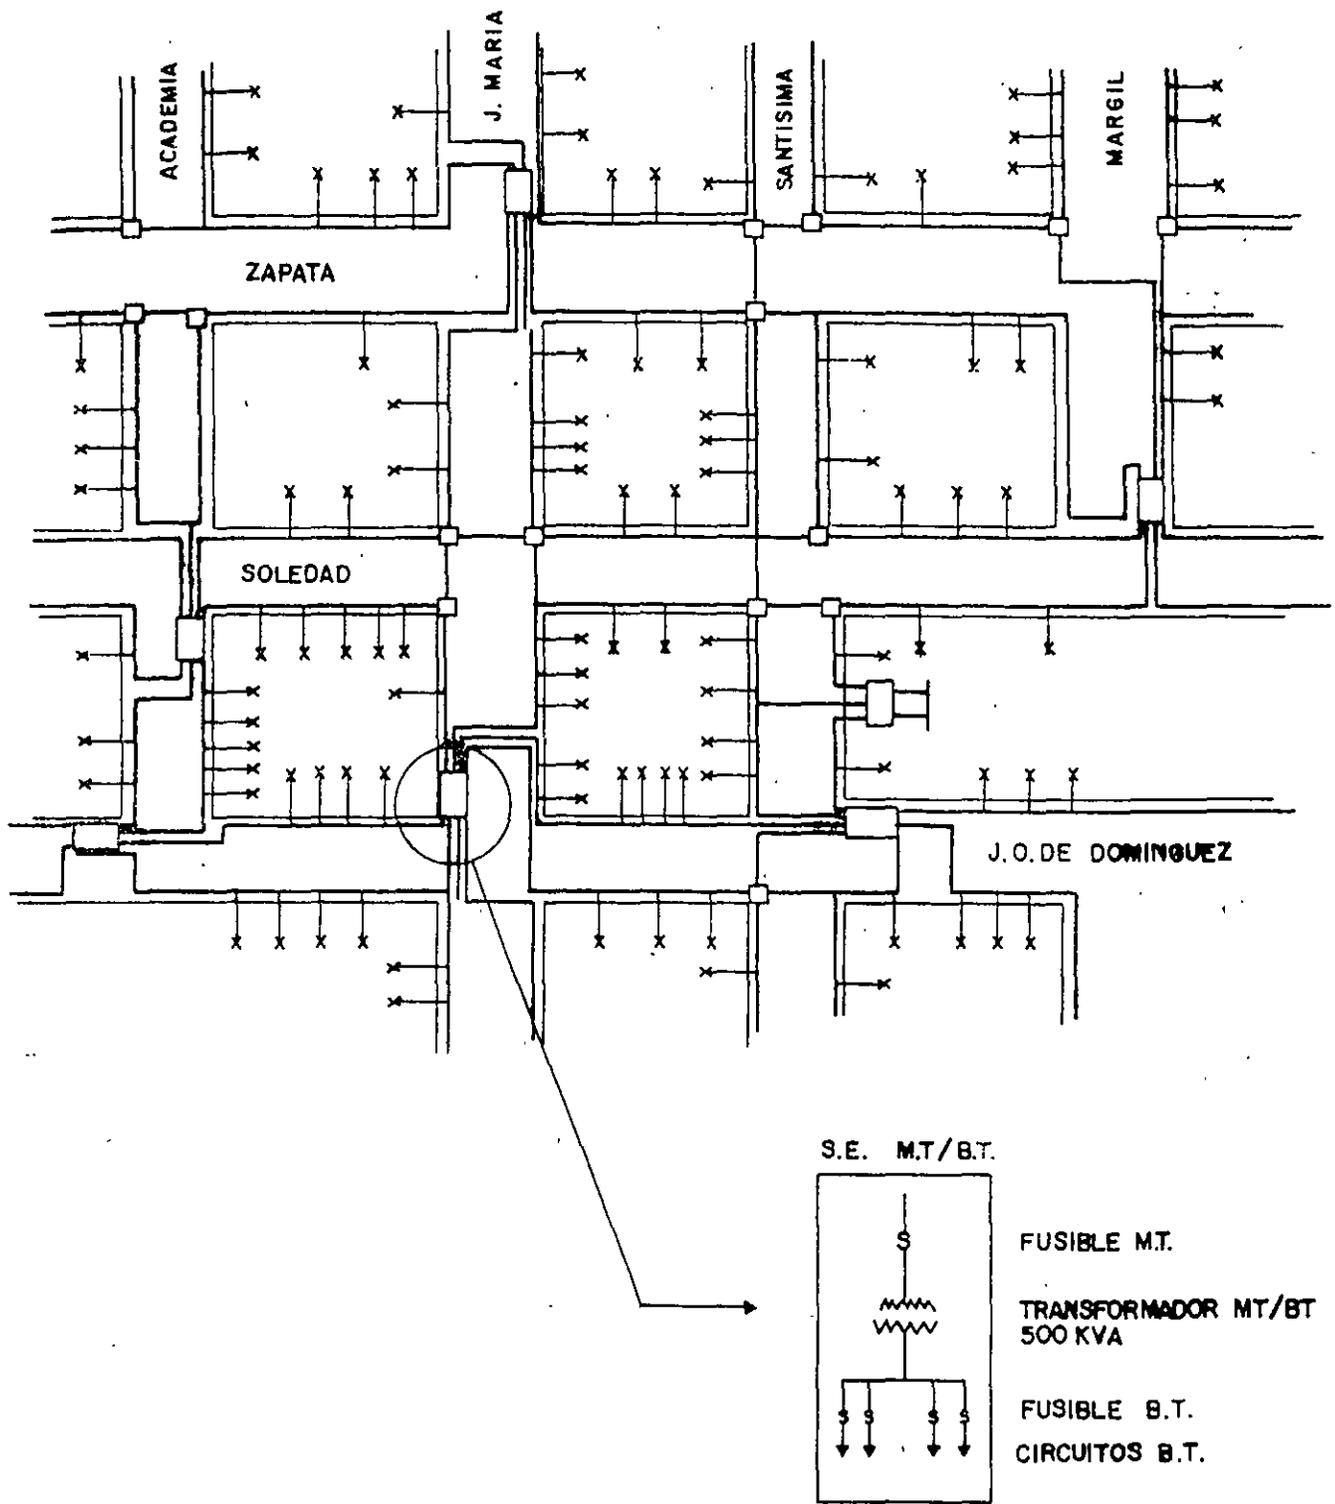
ESTRUCTURA DE BAJA TENSION CON SECCIONAMIENTO
